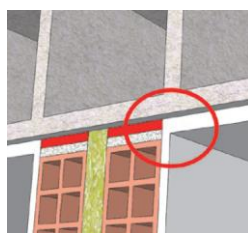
Acumulação de argamassa entre panos da alvenaria (adaptado de Details, 2004)
